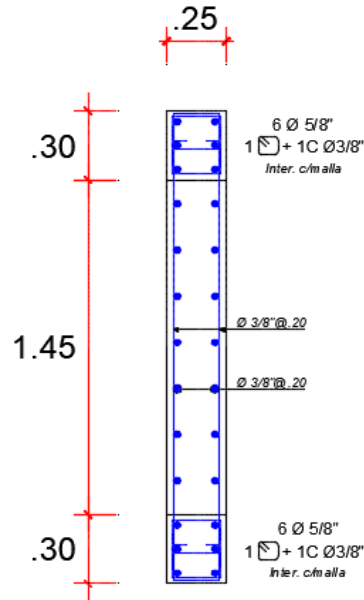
Distribución de refuerzo para placa PL-1 en niveles 1 y 2
